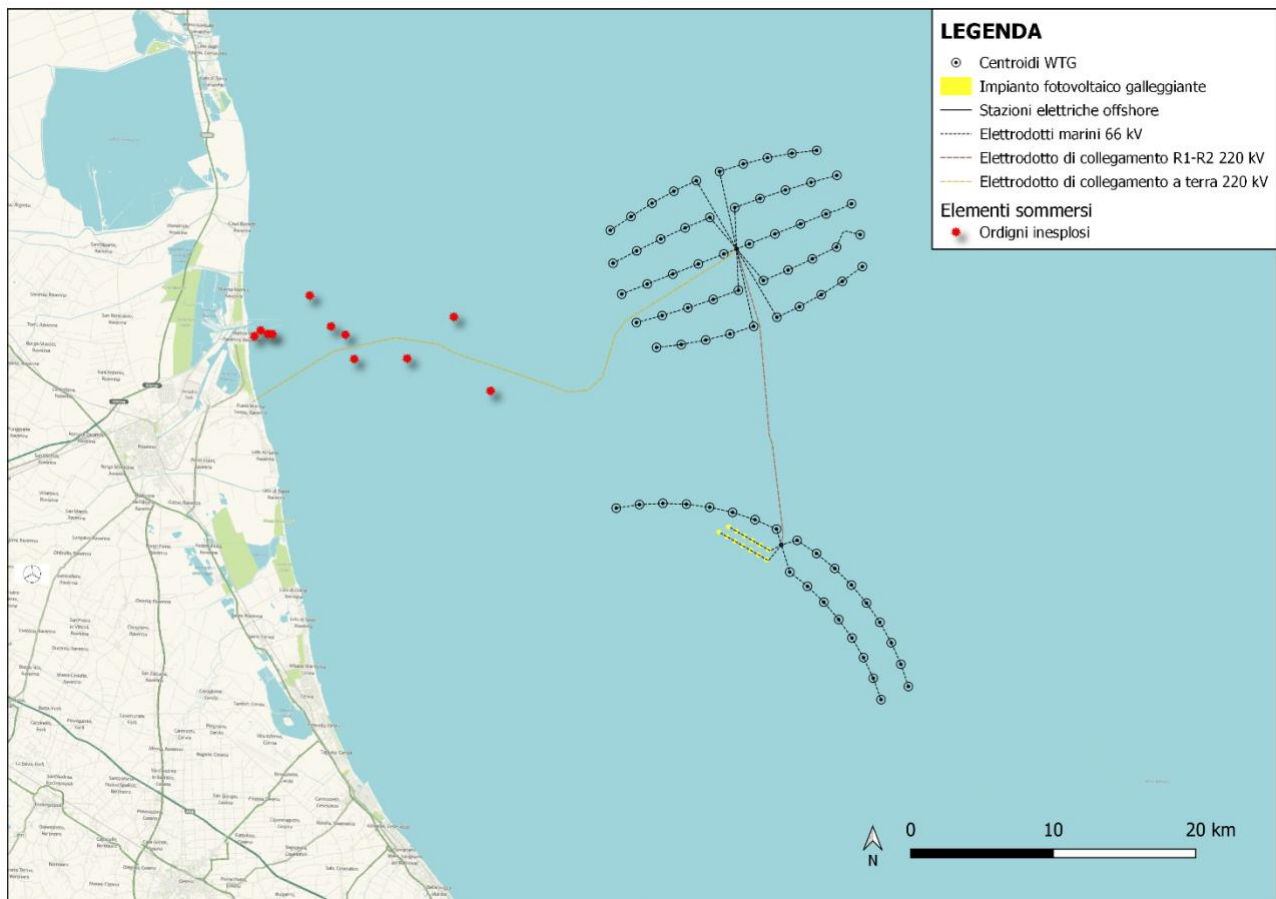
Planimetria di progetto su posizioni ordigni bellici inesplosi
